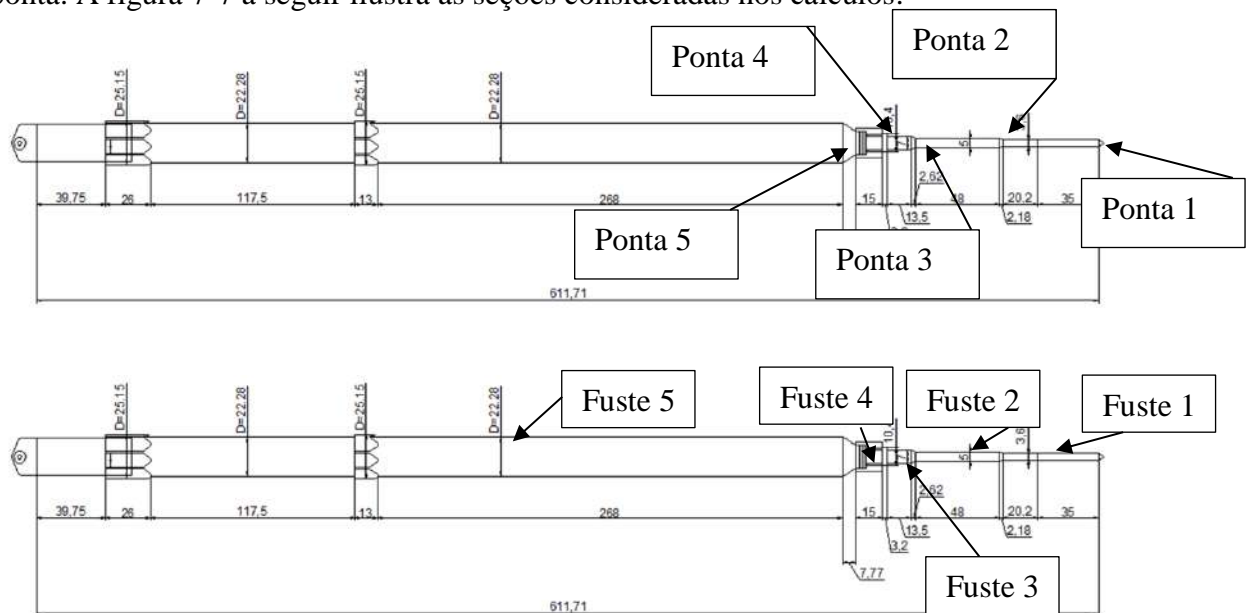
Geometrias consideradas para o cálculo da área lateral e de ponta, acumuladas durante a cravação
